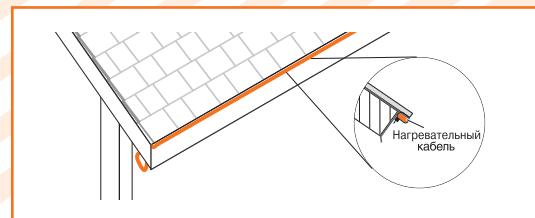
Укладка кабеля по схеме “ капающая ” грань
